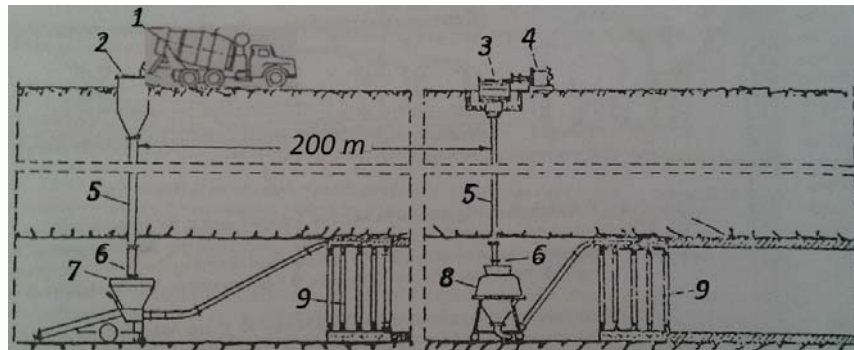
Betonierung durch Abgabe der Betonmischung von der Oberfläche; 1 – Betonlieferwagen; 2 – Trichter; 3 – Schnecke; 4 – Motor; 5 – Betonleitung; 6 – Schieber; 7 – Kolbenbetonpumpe; 8 – pneumatische Betonpumpe; 9 – Schalungseinheit<sup>2</sup>
